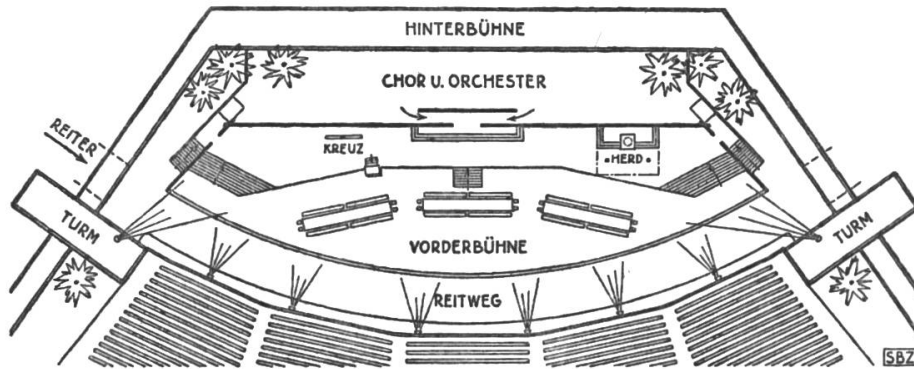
Bundesfeier-Bühne Schwyz 1941. Arch. Hans Hofmann. Grundriss.
